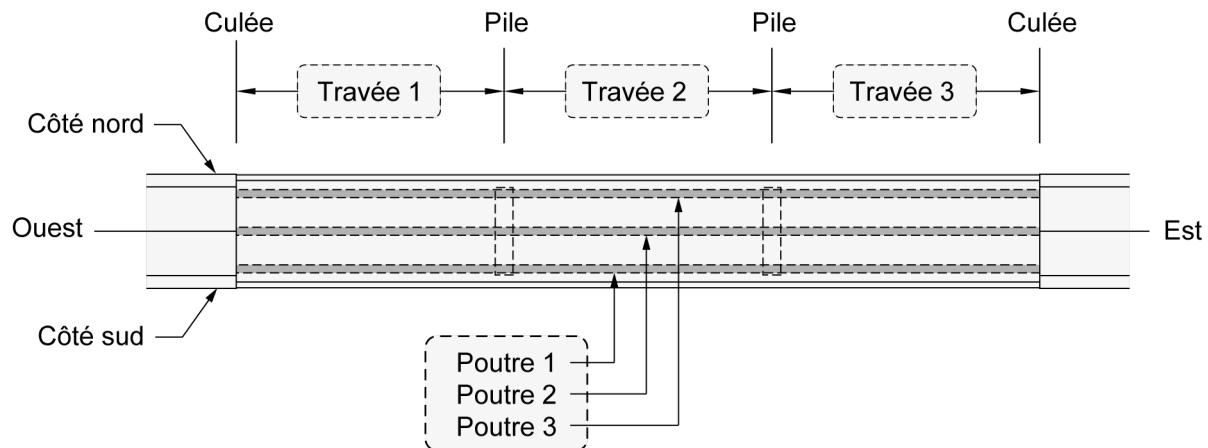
Numérotation selon les poutres – orientation est-ouest de la route
